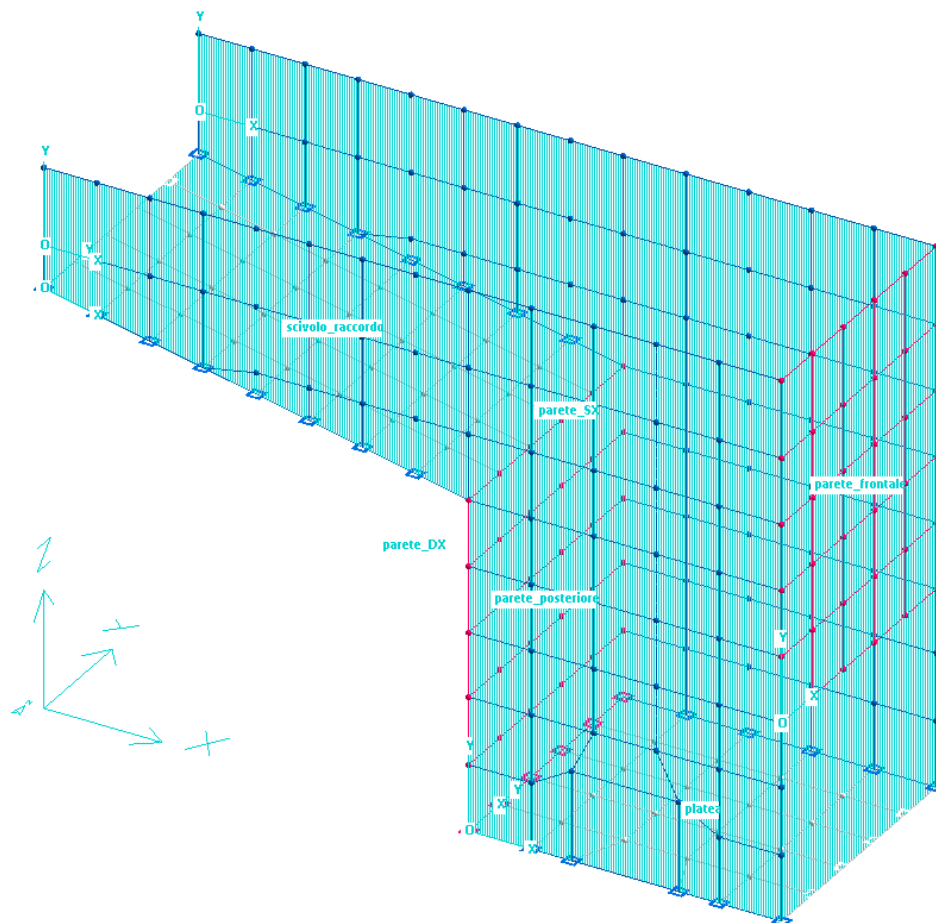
Manufatto di imbocco – modello FEM – denominazione elementi strutturali
